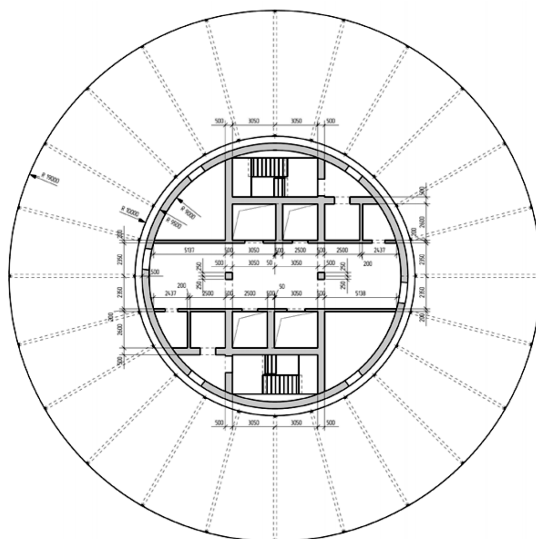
План типового этажа здания со ствольно-подвесной несущей системой
